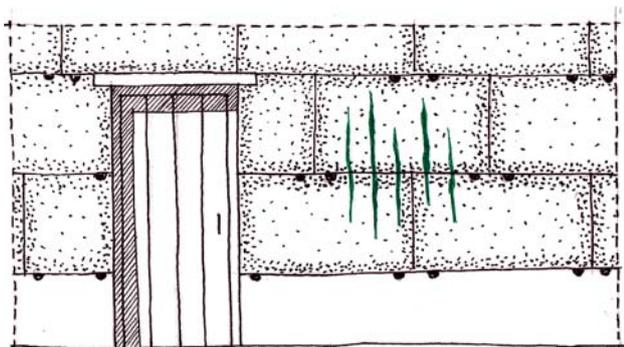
Fisuración por aplastamiento de un muro de tapia.
